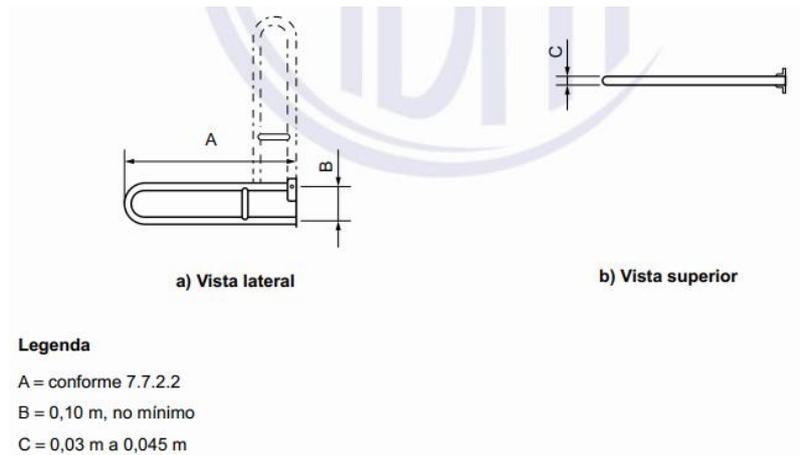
Barra de apoio lateral articulada para bacia sanitária
